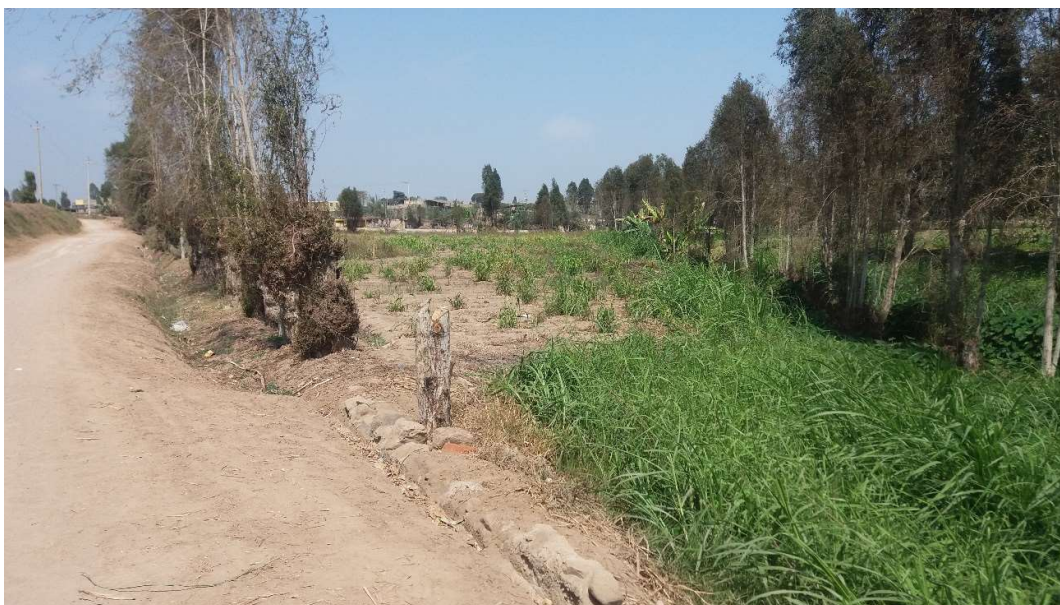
Área en el que se construirá la PTAR, nótese que al cotado del mismo hay un acceso en forma de trocha semi afirmada
